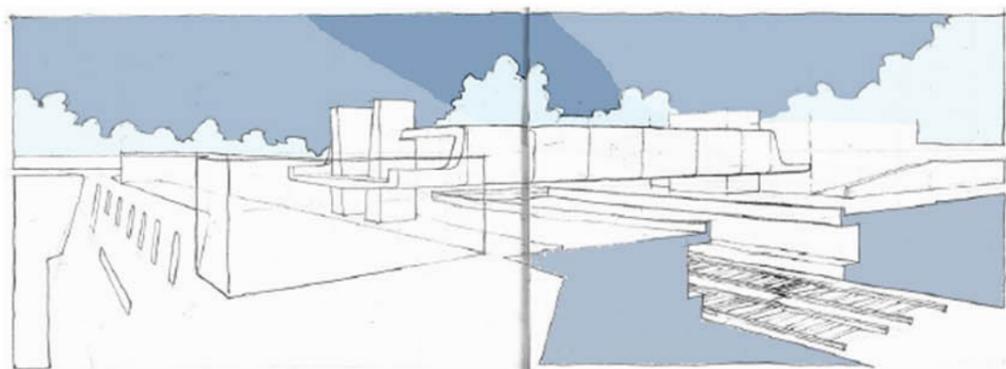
Sezione prospettica Hub Altogarda - ipotesi di lavoro
